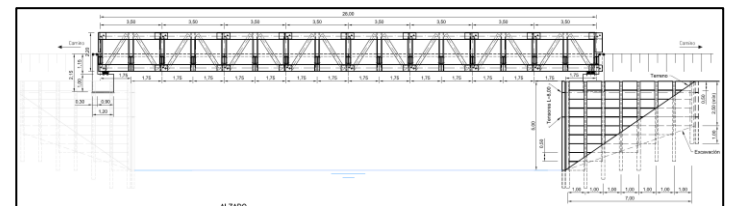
D. Corte longitudinal puente metálico desmontable con 8 módulos.
